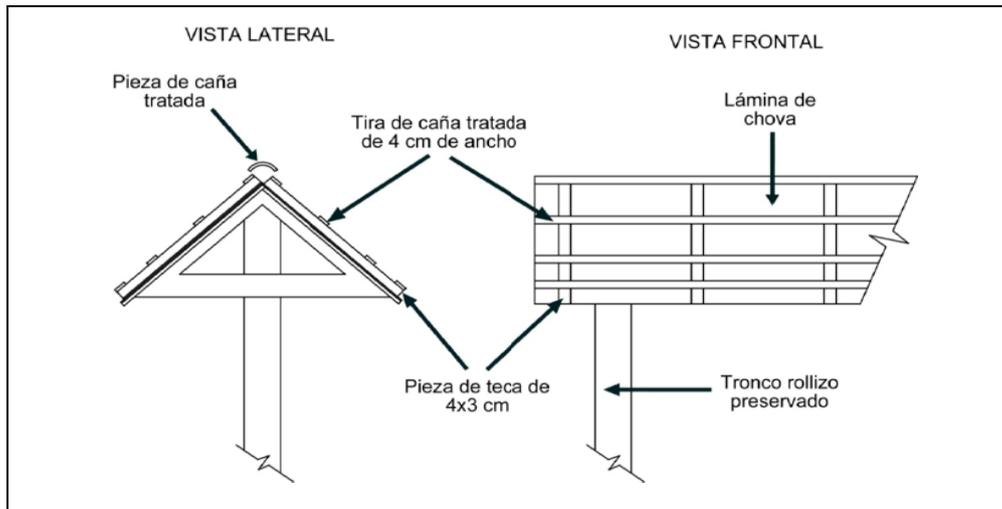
Detalles de la armazón de madera para fijar la paja
